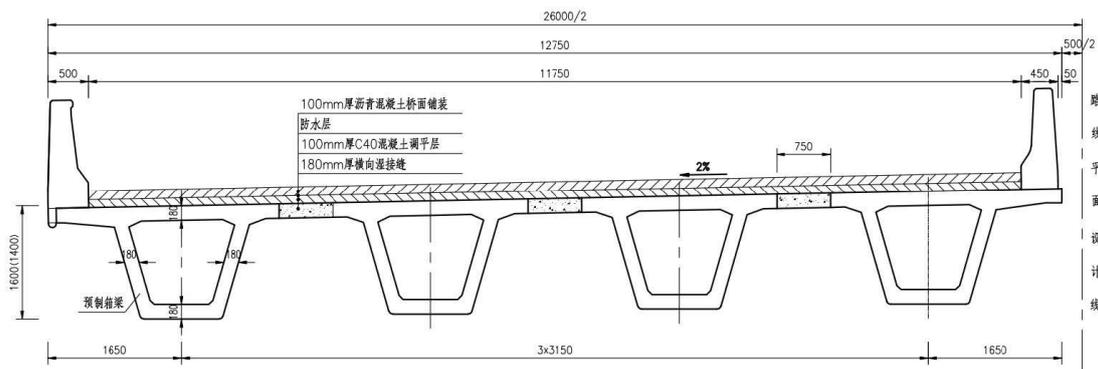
整体式路基段桥梁标准横断面图（单位：cm）
